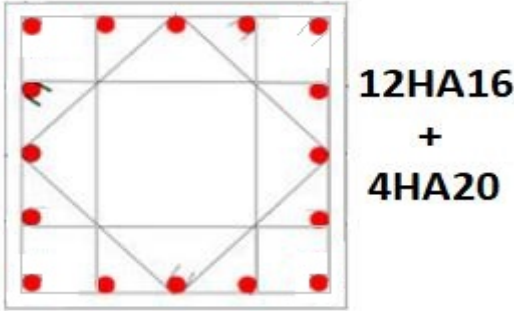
Schéma de ferraillage des poteaux de section 55 X 55 cm
